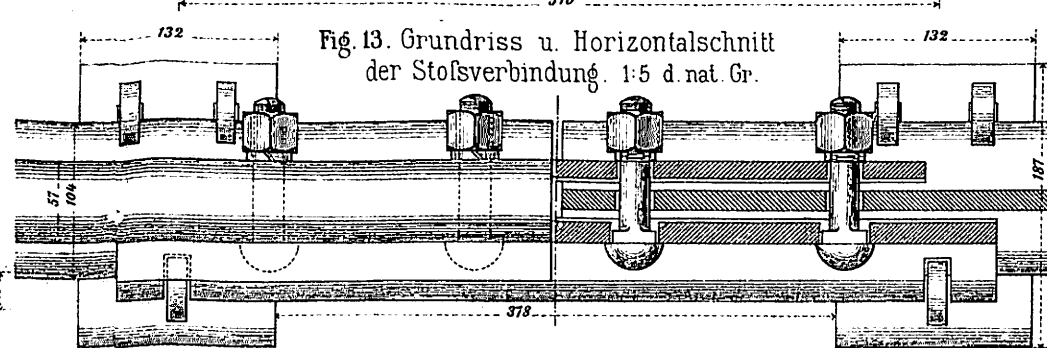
Grundriss u. Horizontalschnitt der Stoßverbindung. 1:5 d. nat. Gr.
